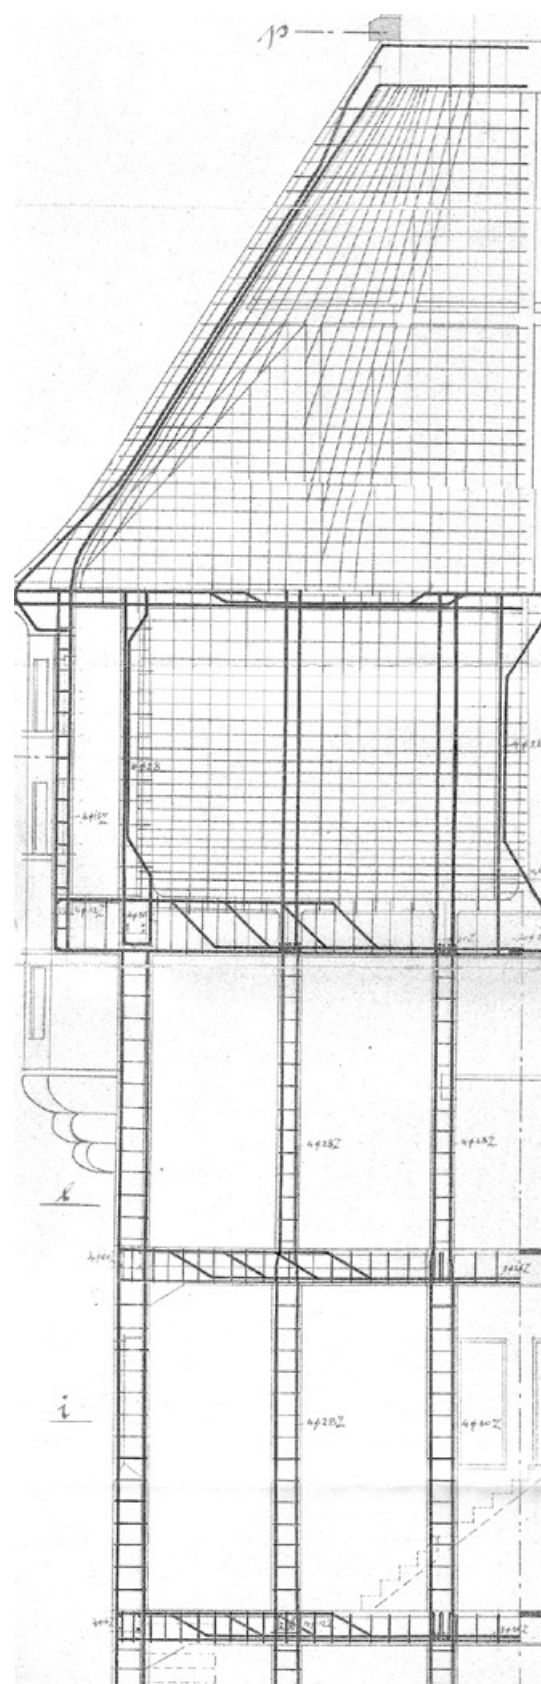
Ausschnitt aus dem Bewehrungsplan von Thormann + Stiefel 1909 (Archiv Stadt Schwabmünchen).
